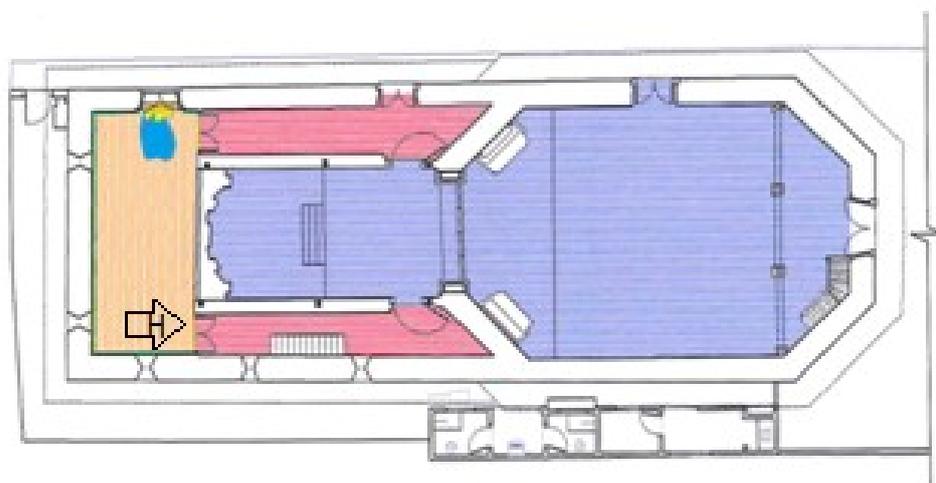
Vista H – Entrada lateral esquerda Sacristia - Planta pavimento inferior Capela Sem escala
